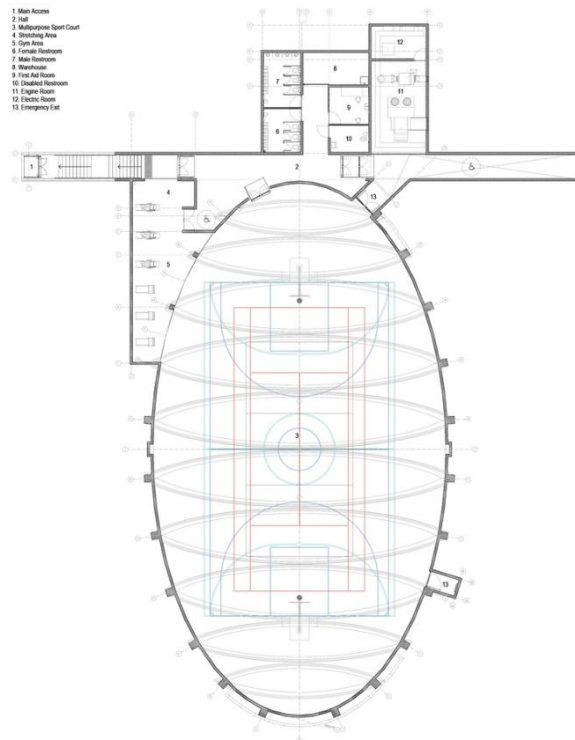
Planta Arquitectónica del Complejo, Extraída de archdaily.
